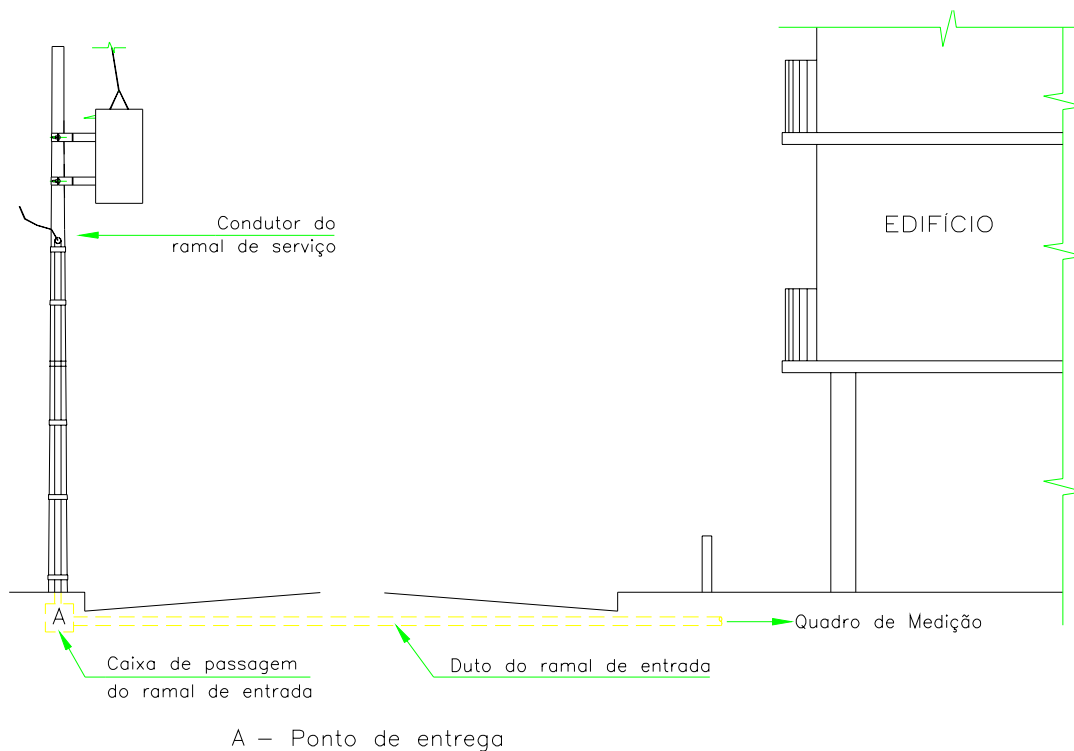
Ramal de Entrada Subterrâneo Atravessando a Rua
